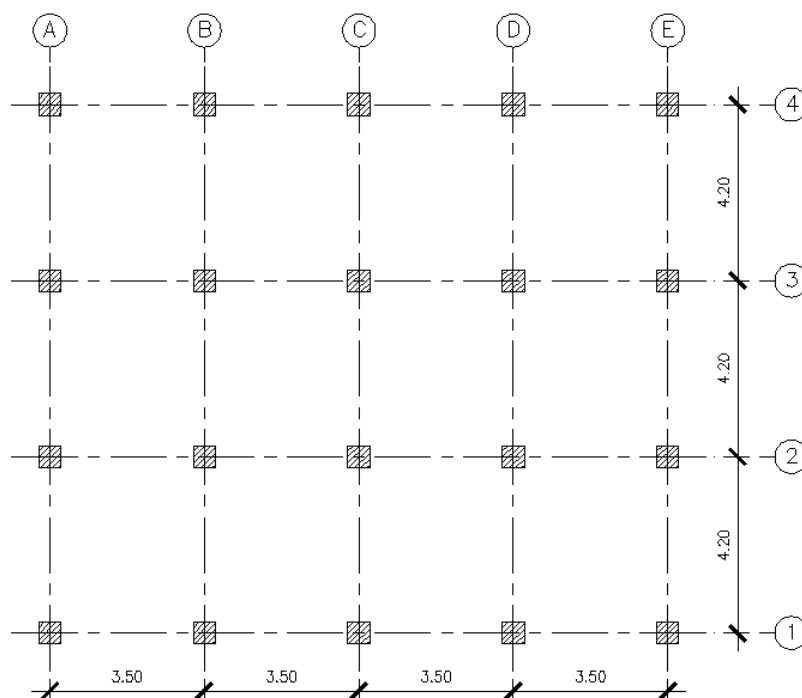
Vue en plan Modèle de la construction individuelle
